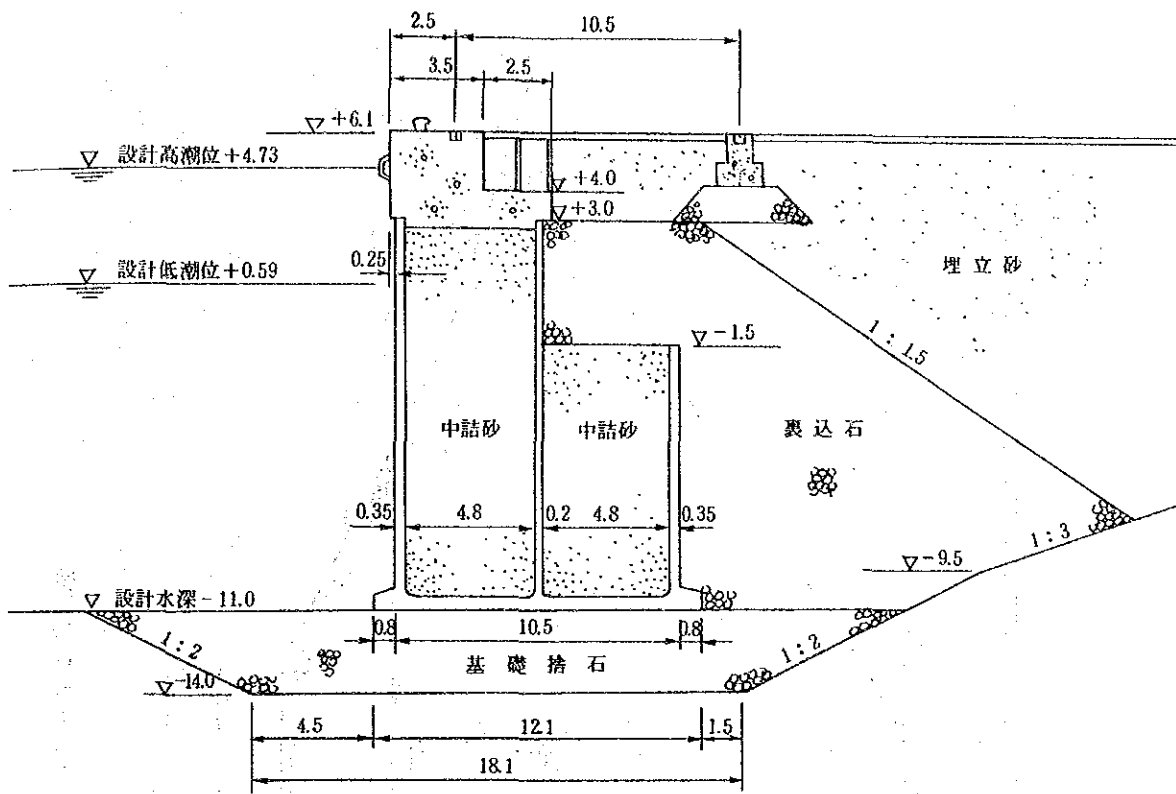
11.0M岸壁標準断面・平面図 (ケーソン案)
